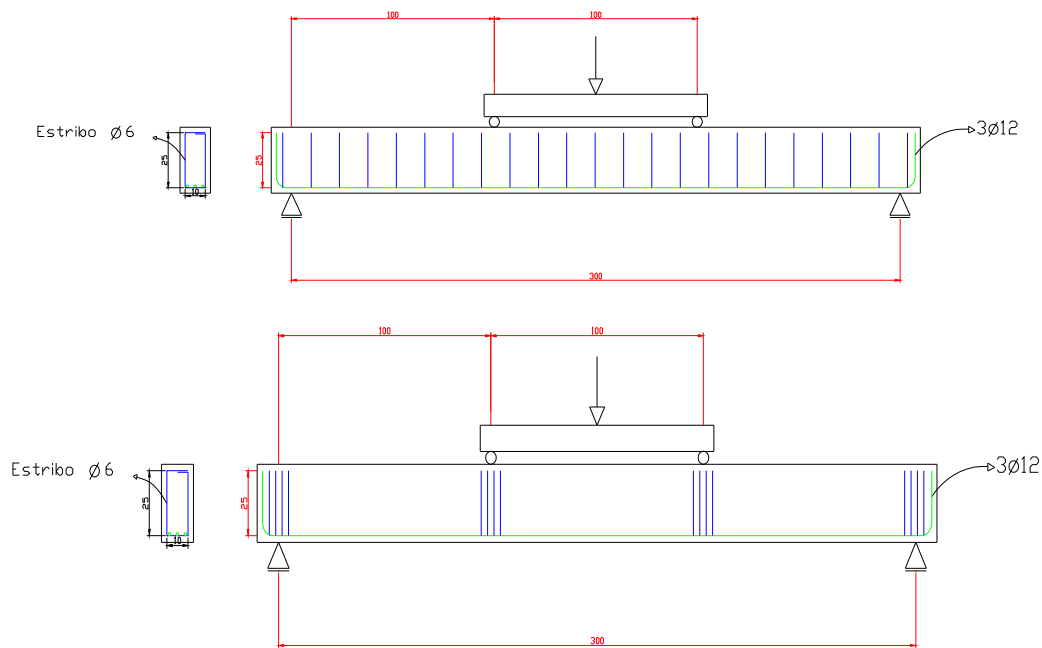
Eschema de armado longitudinal y estribado de vigas. Diagrama de carga del ensayo. Serie B
